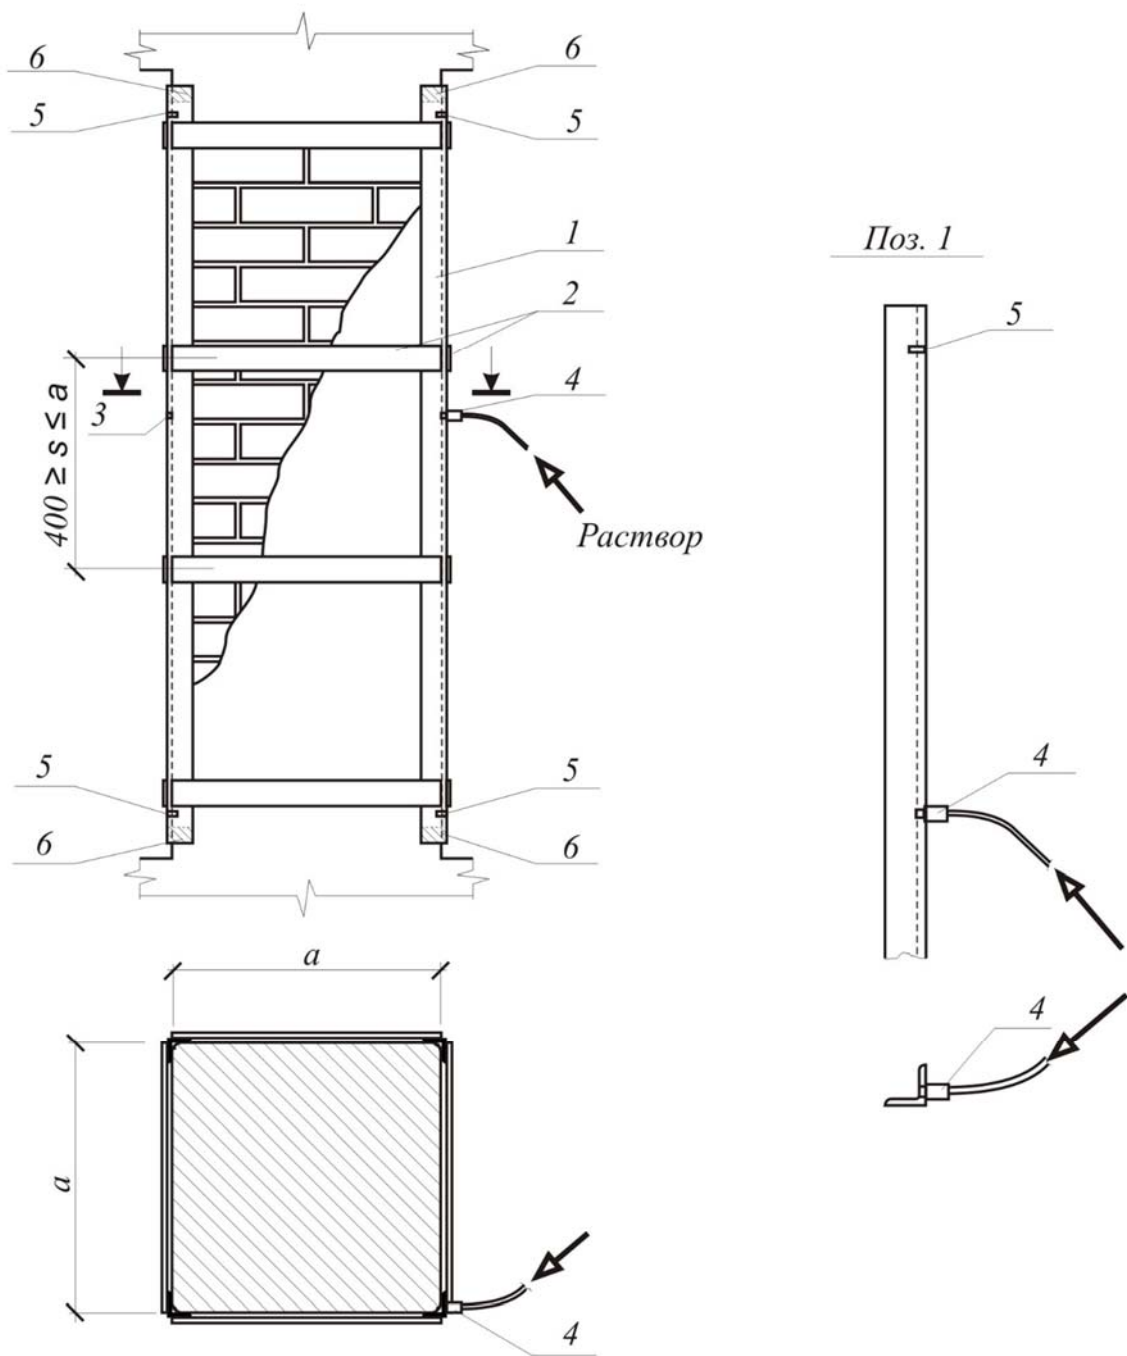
Схема усиления кирпичного простенка стальной облоймой:
